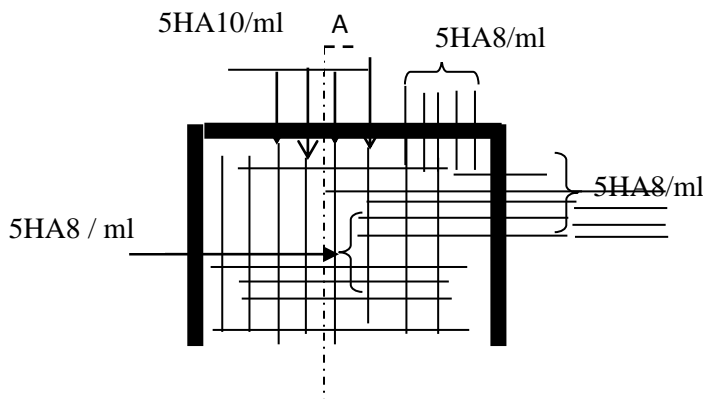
Schéma du ferrailage de dalle sur trois appuis
